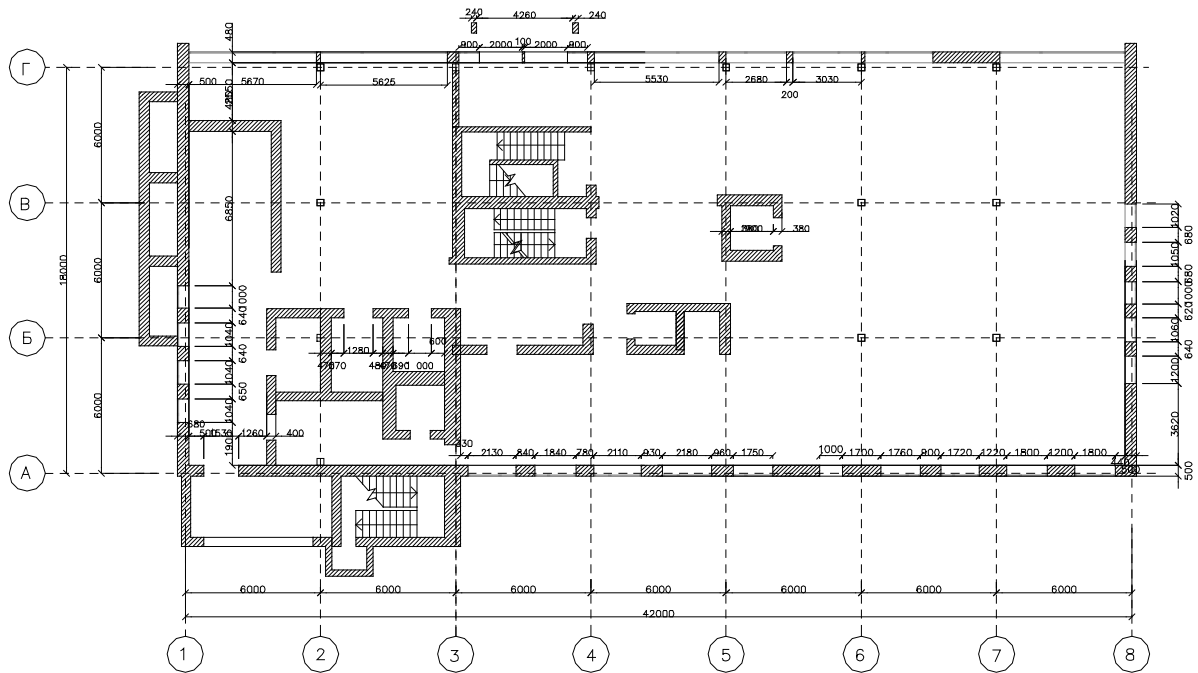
План 1-го этажа здания столовой в пос. Заозёрное г. Евпатории
